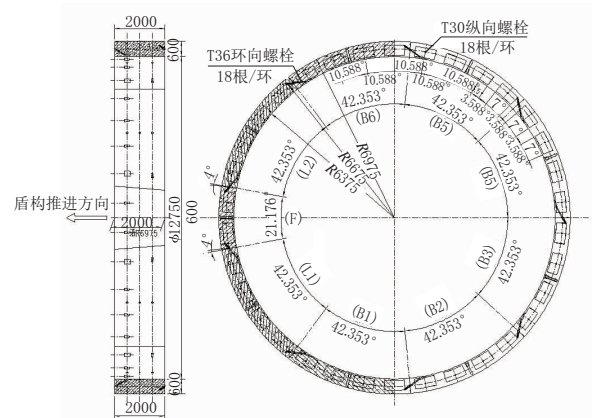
圆形隧道盾构中心纵断面示意图(单位:mm)
